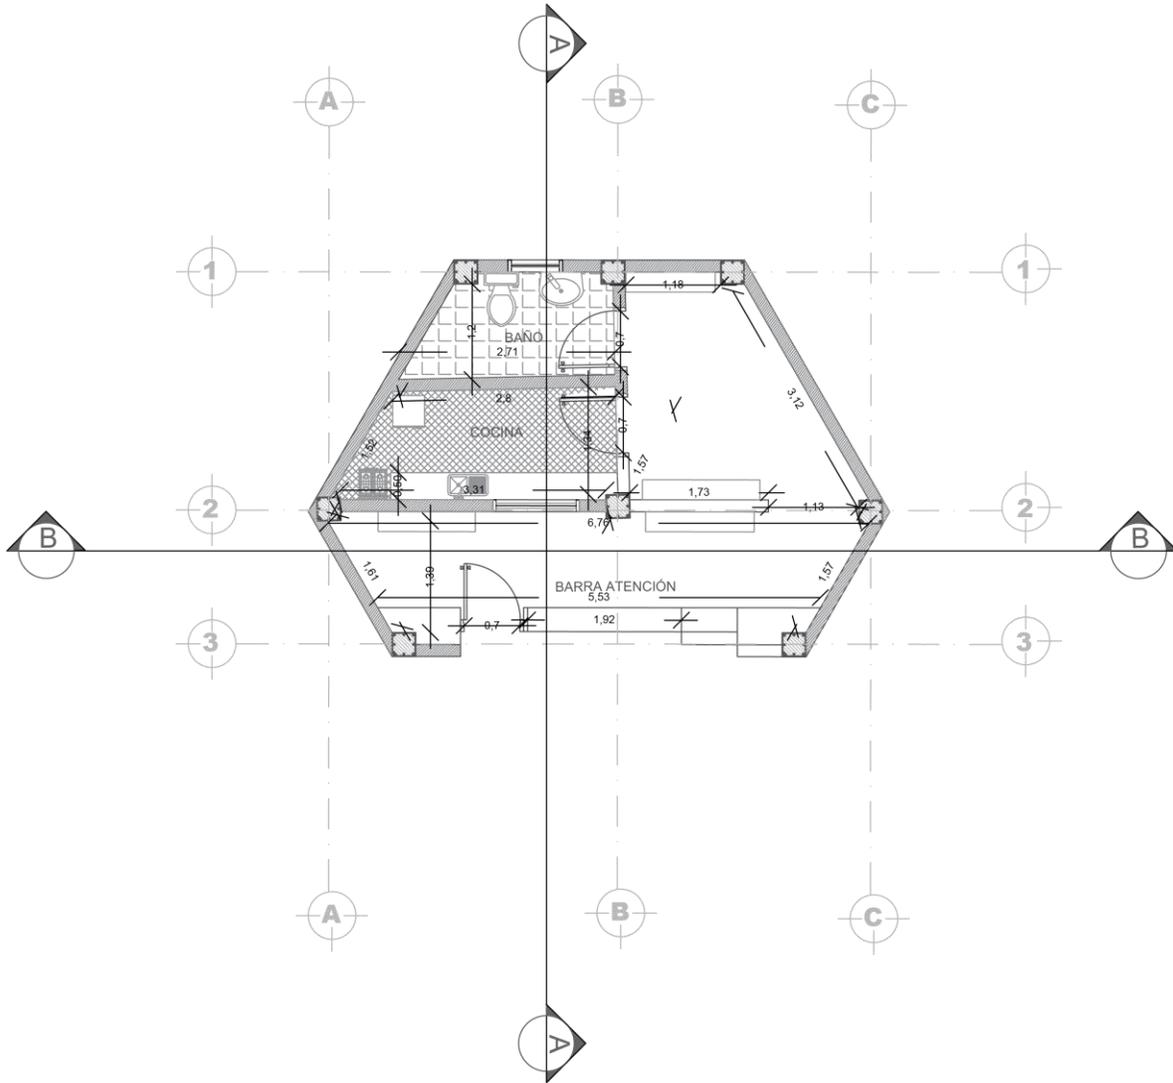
Planta arquitectónica cafetería; Fuente: elaboración propia
